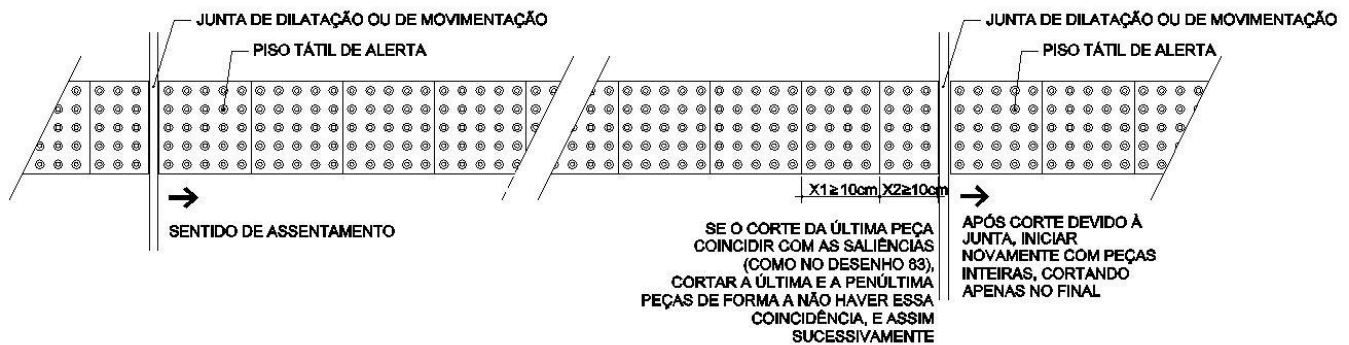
Cortes e emendas de piso tátil de alerta – Corte de duas peças
